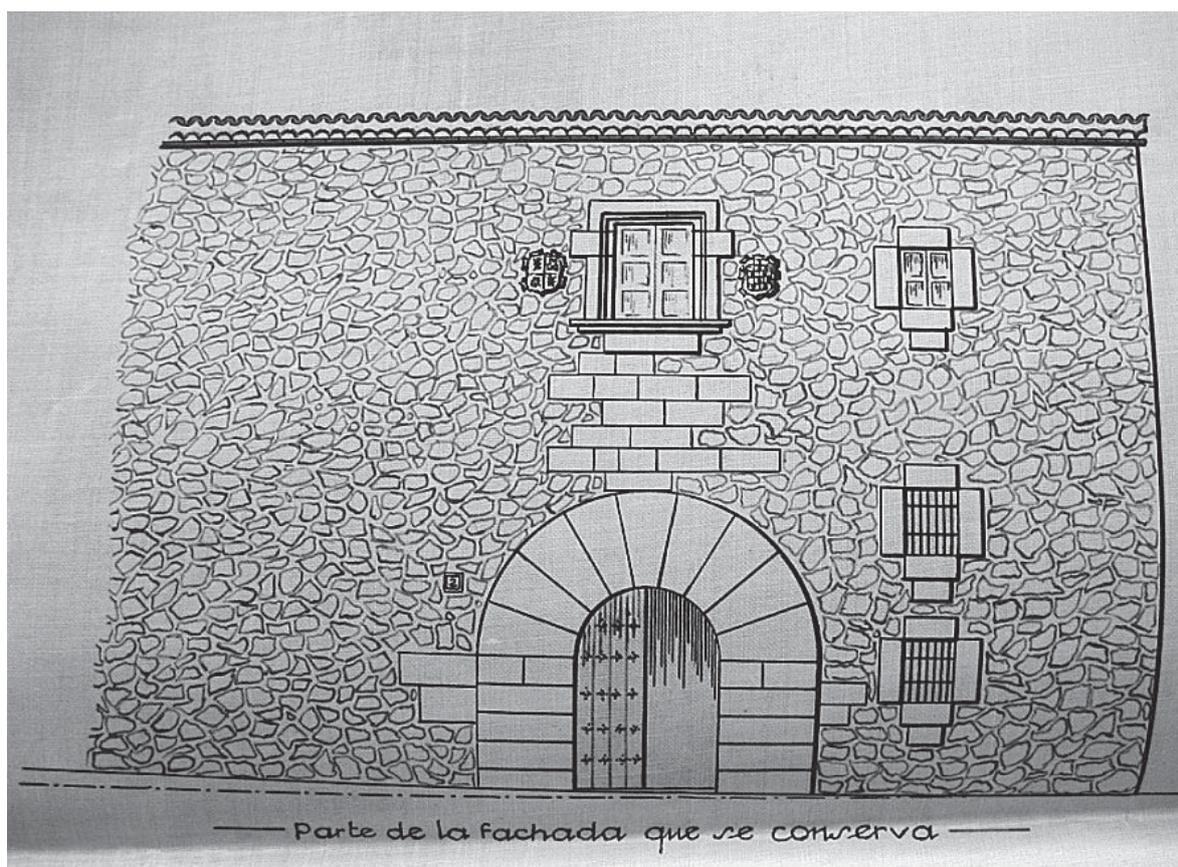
Alzado de la fachada principal (A.H.M.C.C.).
